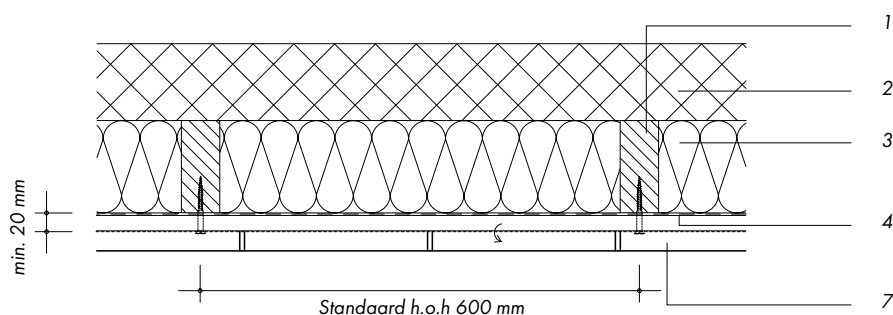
achterconstructie RHEINZINK-fels-, roeven- en losangegevel (verticaal detail)
